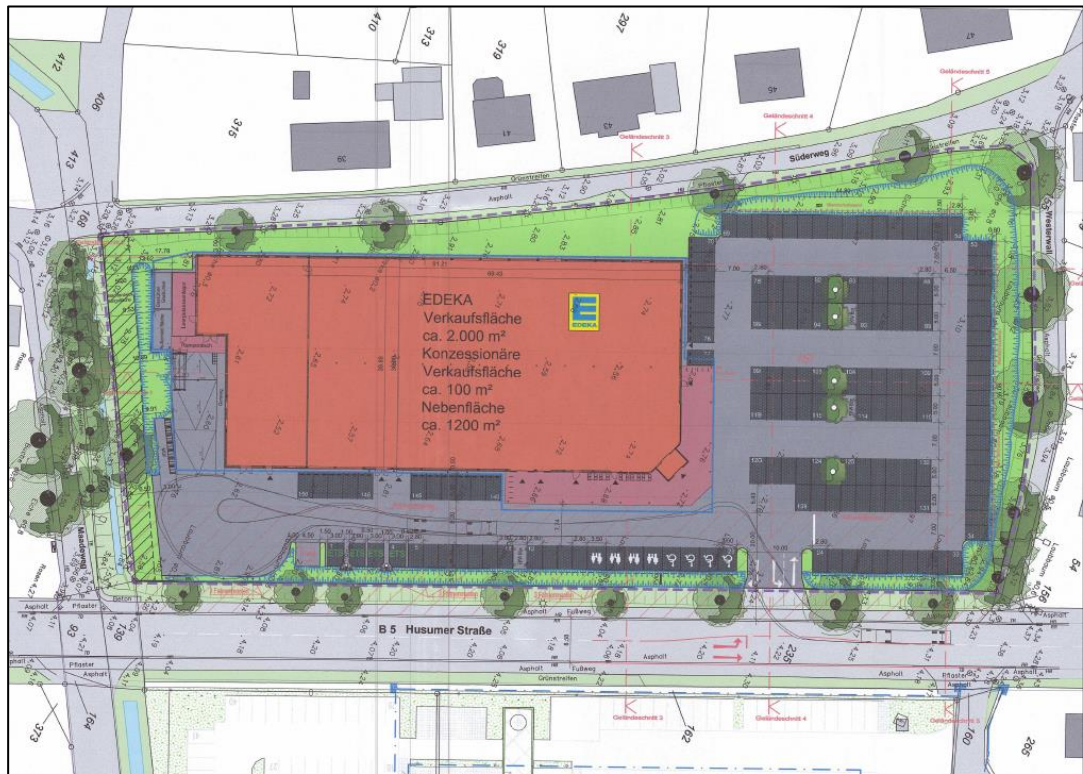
Lageplan des EDEKA-Vorhabens an der Husumer Straße (B 5) in Breklum¹²
